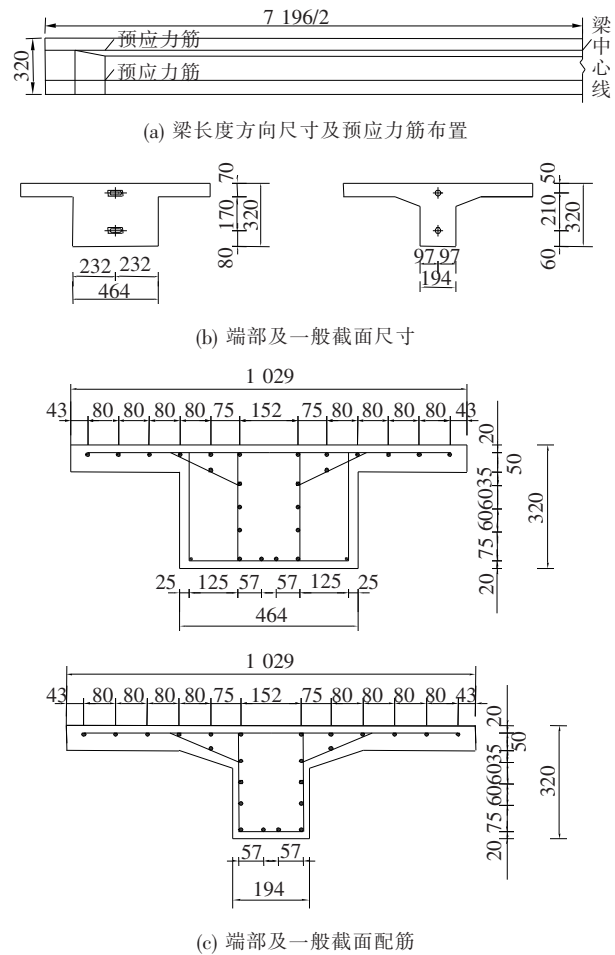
预应力混凝土模型梁尺寸及配筋(单位:mm)
